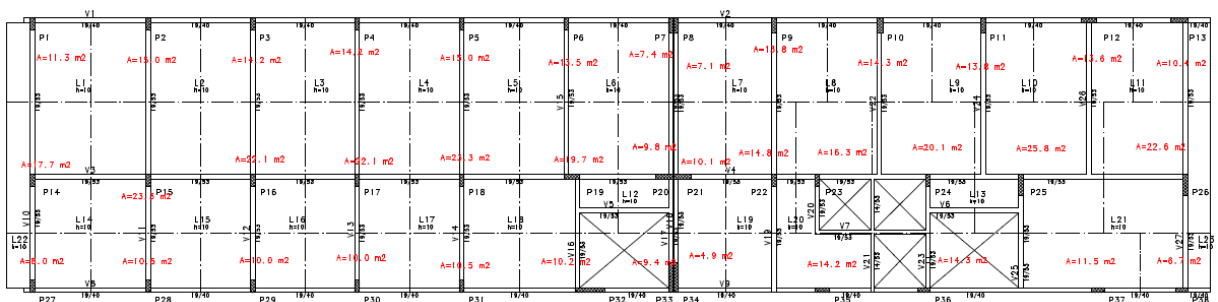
Pavimento Tipo com as áreas de influência de pilares. (Fonte: Autor, 2023)
